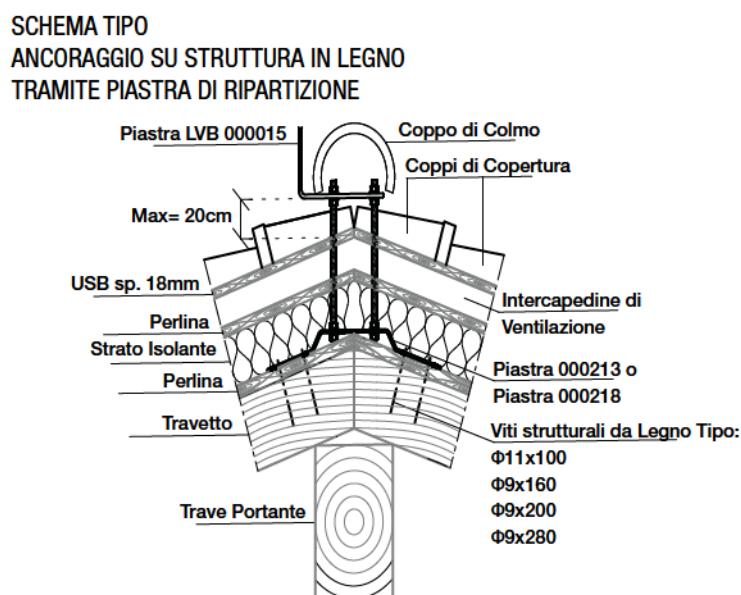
Sezione del dispositivo LVB fissato con piastra di ripartizione carichi da colmo su struttura di supporto in legno.
